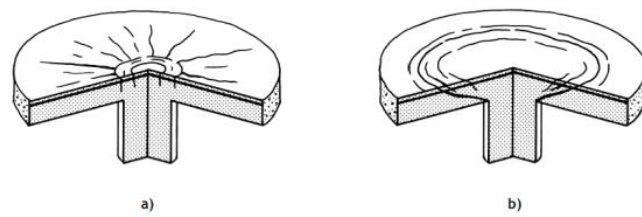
Representação esquemática da fissuração devida a: a) flexão e b) corte [10].
